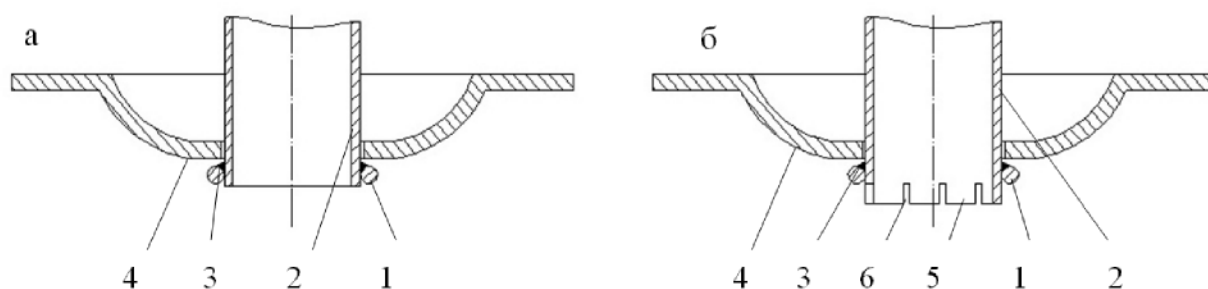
Конструкция опорного узла фрикционной анкерной крепи традиционного (а) и усовершенствованного (б) типа: 1 — опорное кольцо, 2 — стержень, 3 — сварной шов, 4 — опорная плита, 5 — сектора, 6 — открытый паз
